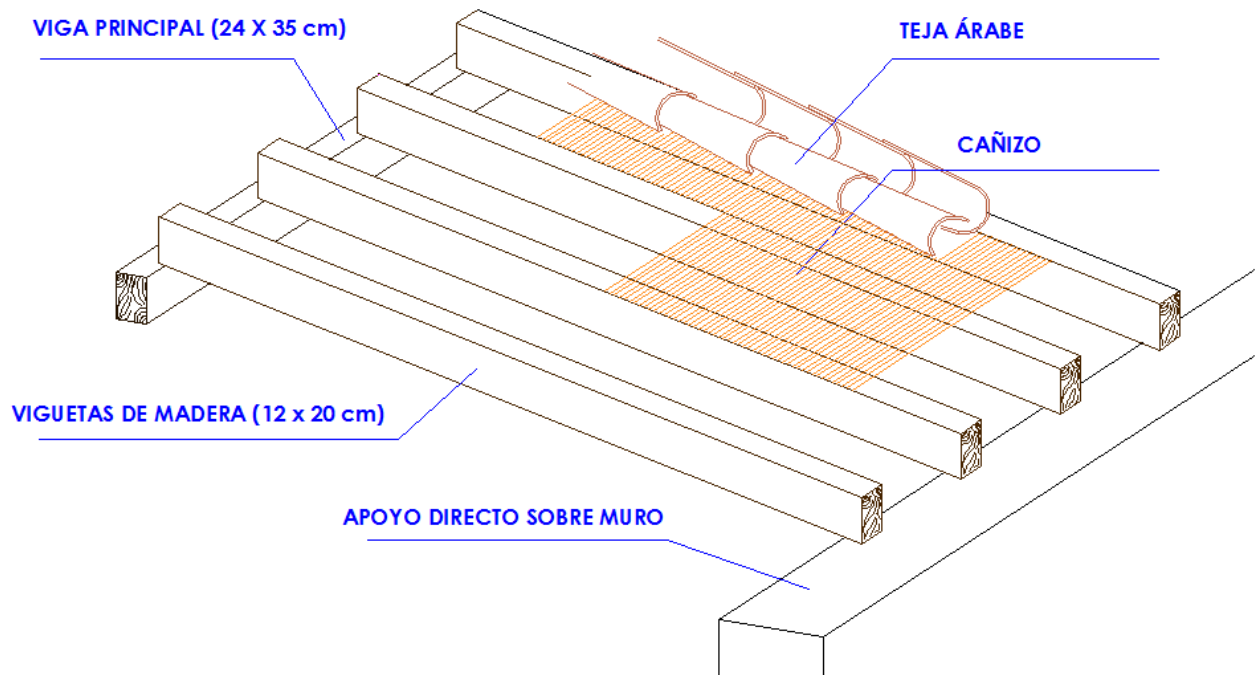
Detalle constructivo de la cubierta (Estado hipotético)
